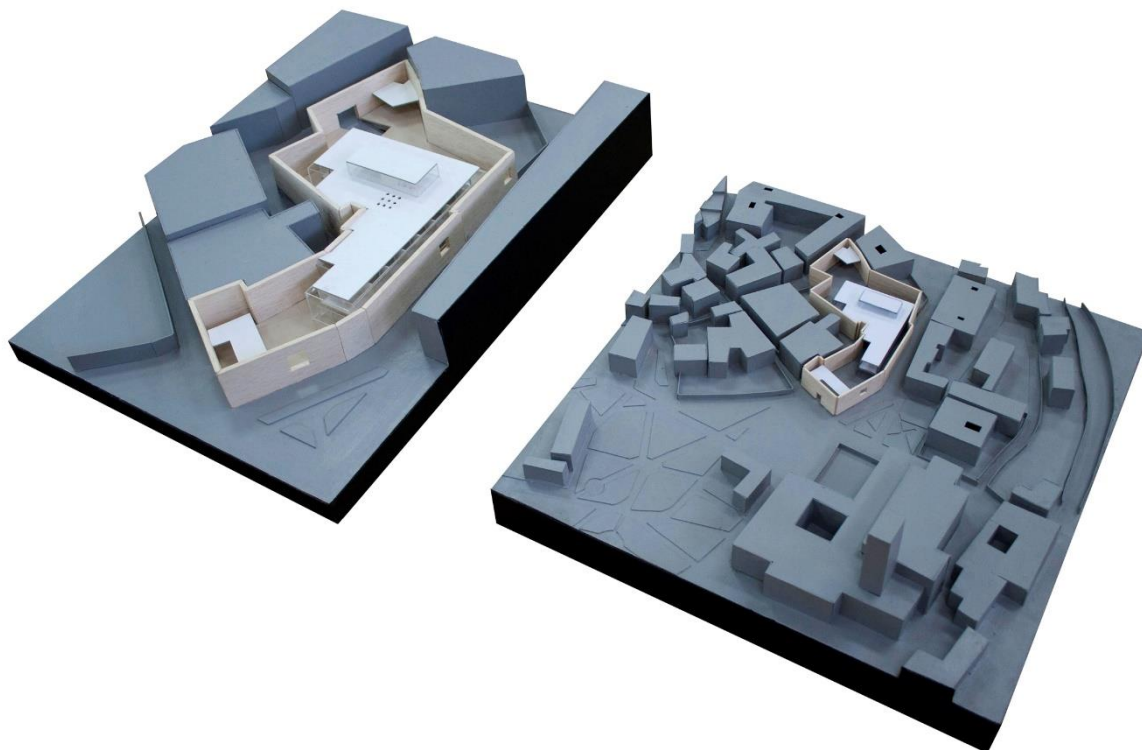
Maqueta del objeto y del conjunto. Oficinas en Zamora. Campo Baeza. Taller de Proyectos 5° / 6° / 7° semestre. Junto a la Prof. Carla Collevocchio. Trabajo de Nastasha Ramirez, Gabriel Marchiani y Elizabeth Troconis. UD9. FAU. UCV (2013).
